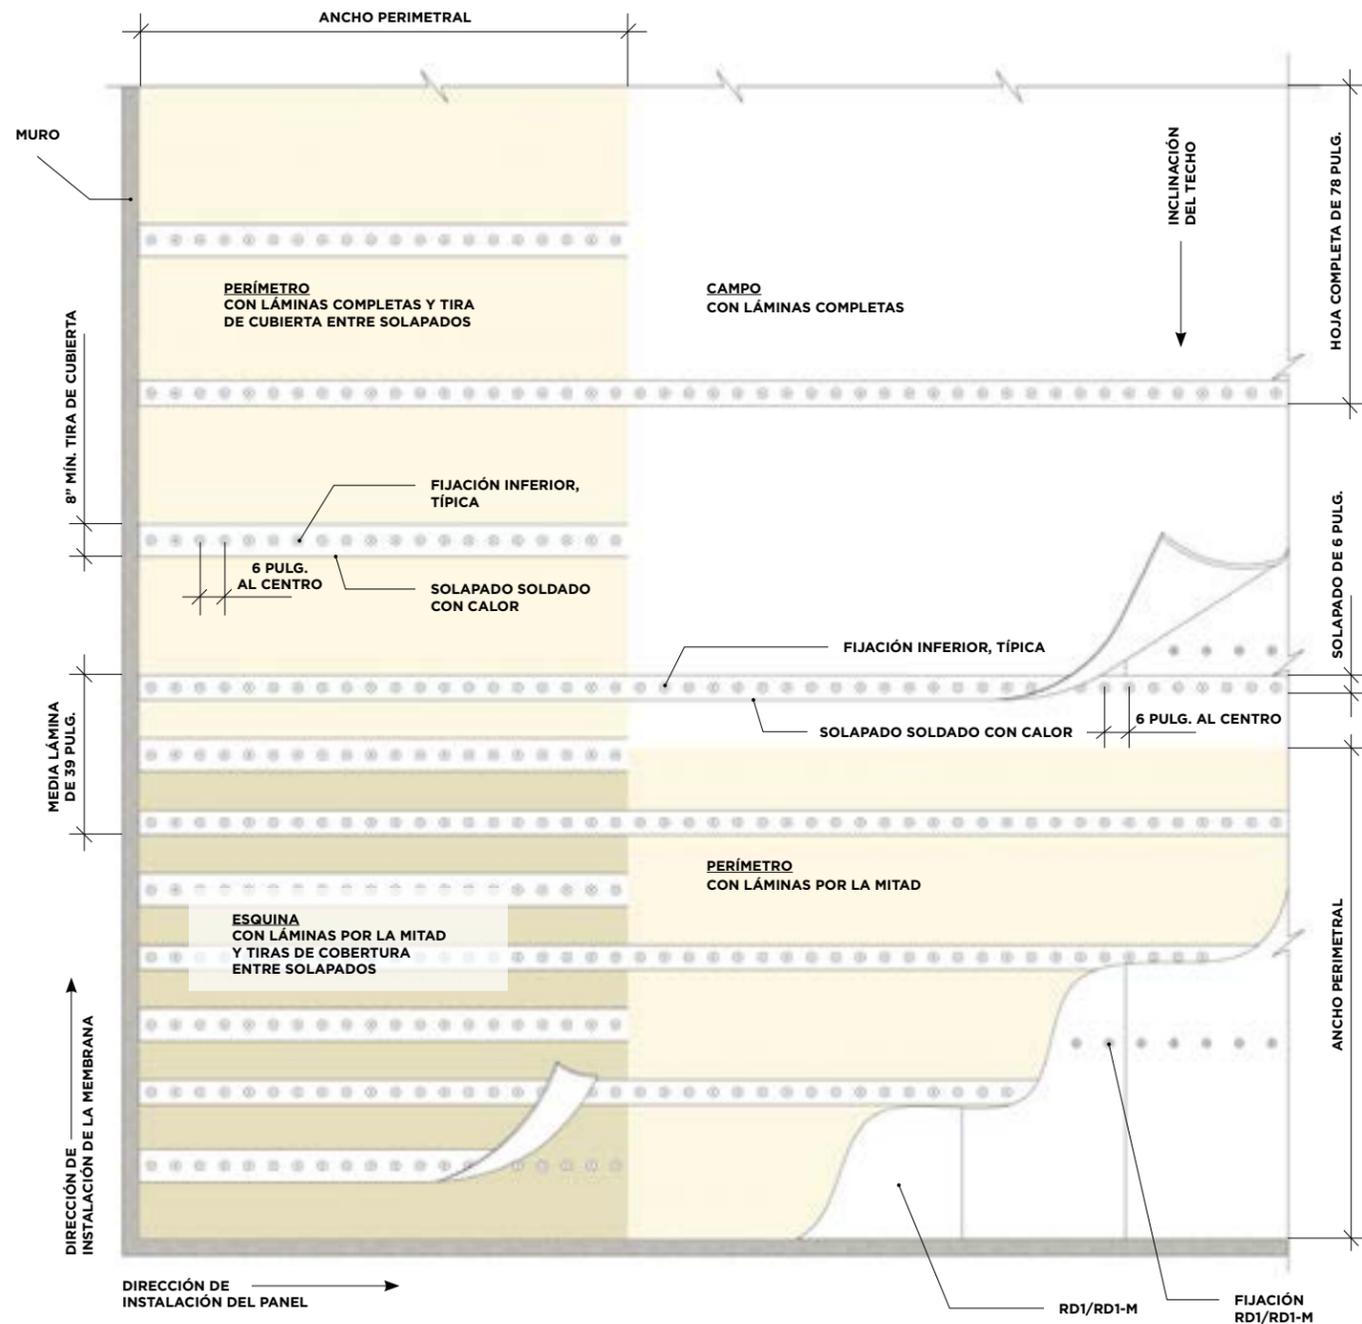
MEMBRANA DE TPO/PVC ONEDEK FIJADA MECÁNICAMENTE (USANDO LÁMINAS PERIMENTRALES POR LA MITAD) (VISTA DE PLANTA)
